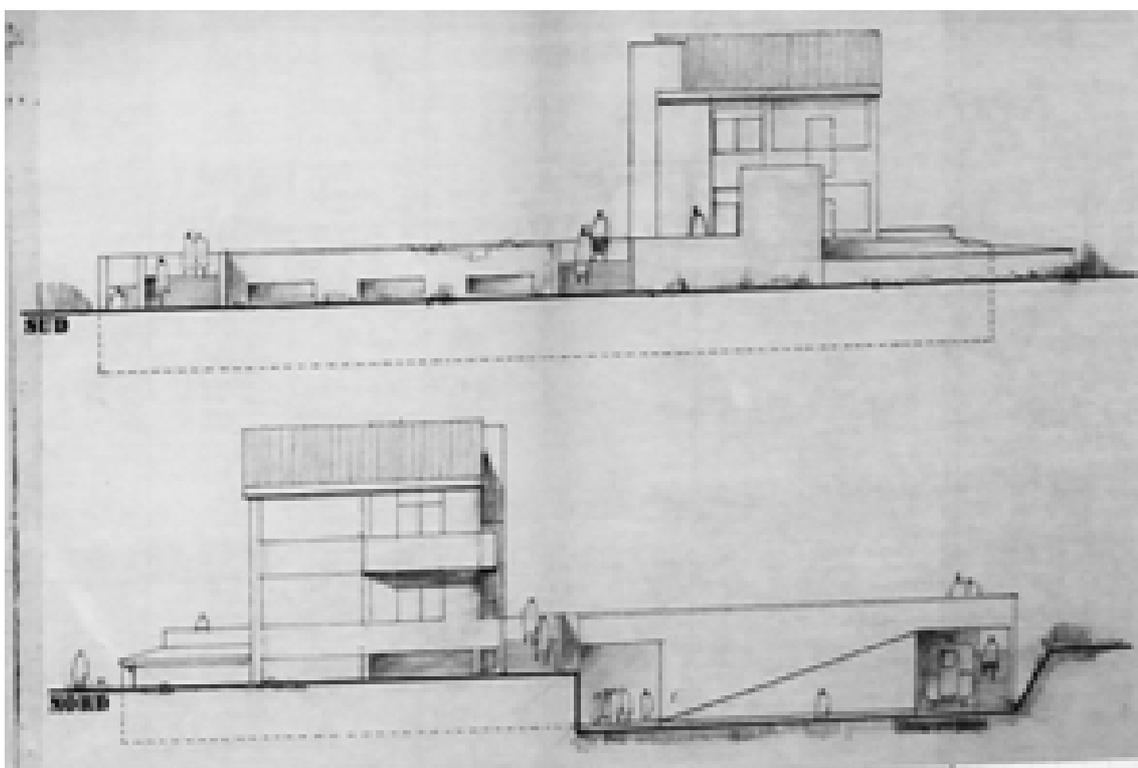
Prospetti Nord-Sud – 02/08/1994 (AABS-64_656)
